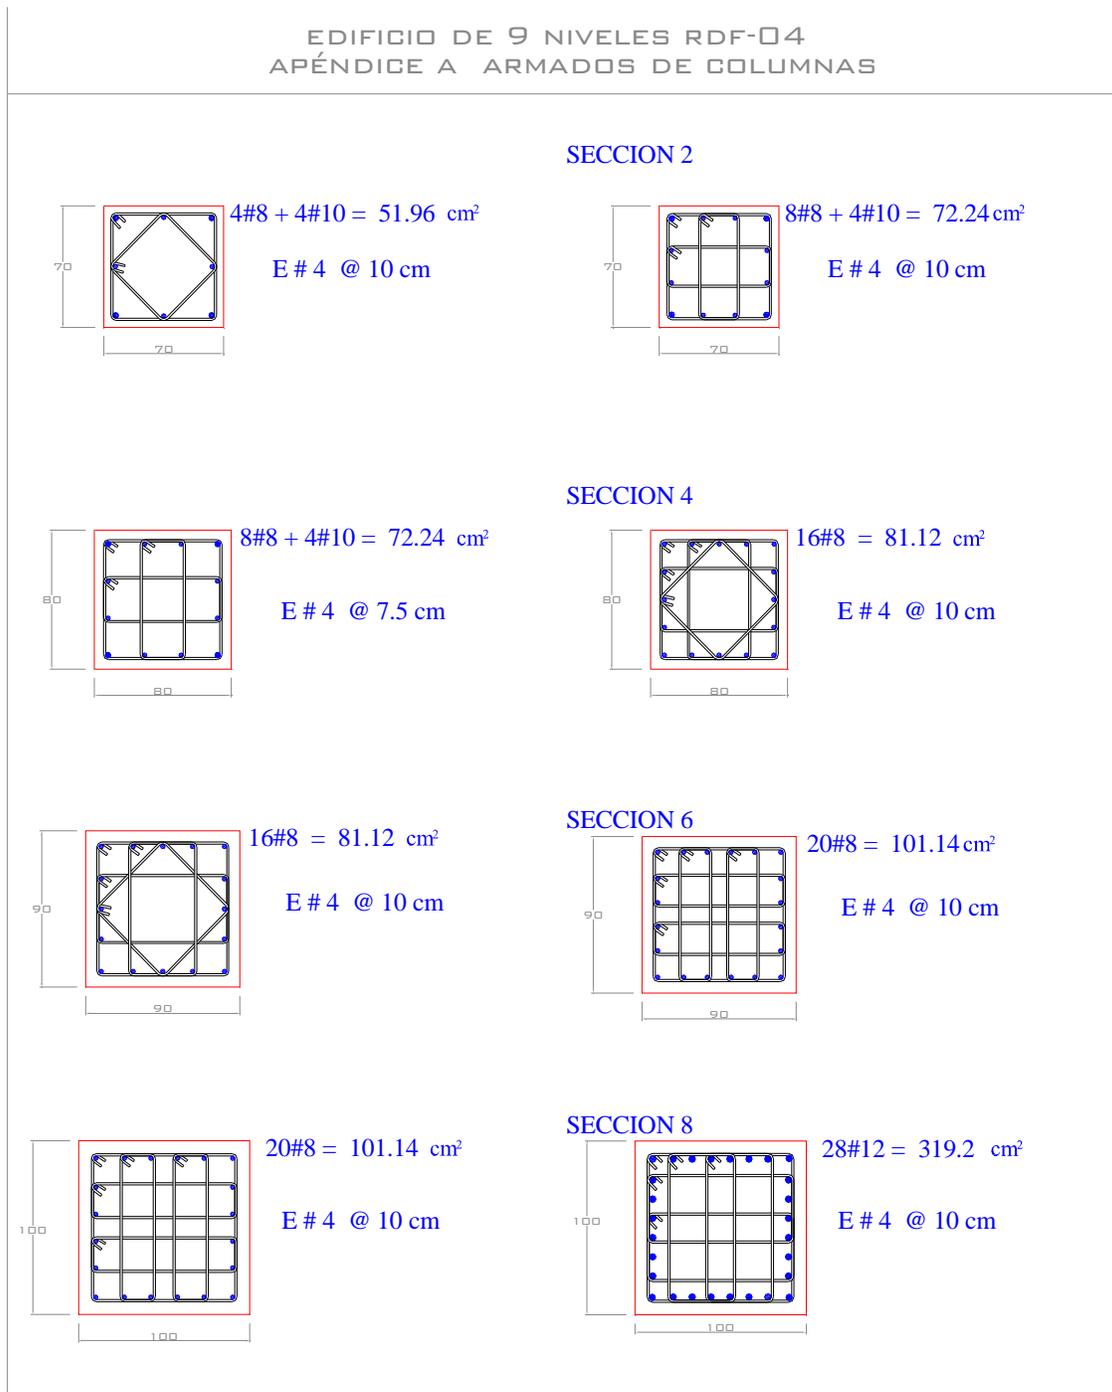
Armados de acero longitudinal y transversal propuestos en columnas del eje C, edificio 9 niveles, Apéndice A (caso B) de las NTC-Sismo, RDF-04
